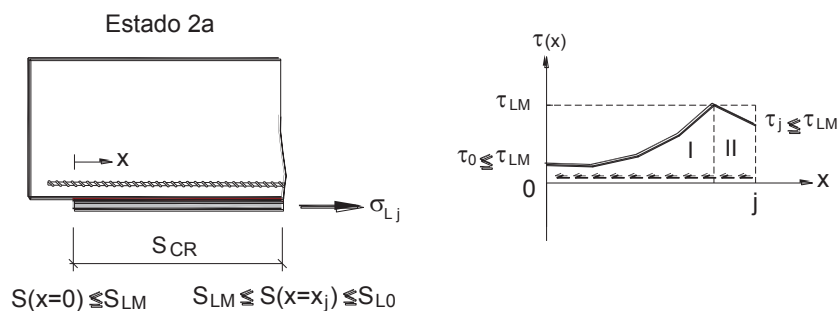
Distribución del esfuerzo cortante en un elemento de viga ubicado entre el extremo de la platina FRP y la grieta  $j$  más cercana, en el estado 2a.
